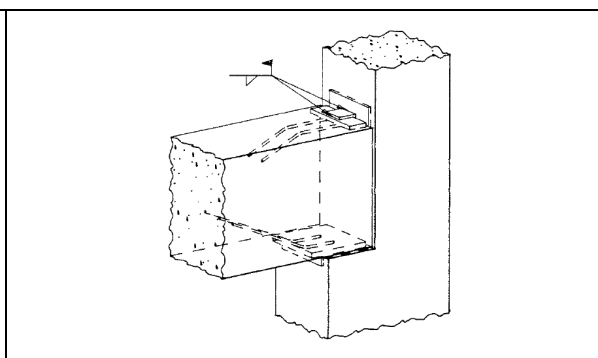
Vigas assentes diretamente num pilar contínuo (Sidney, 2000)
